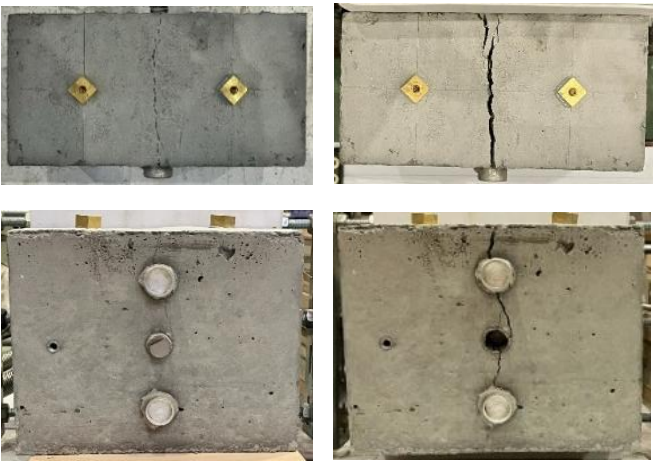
ひび割れ状況 (左: 加力前, 右: 加力後)
